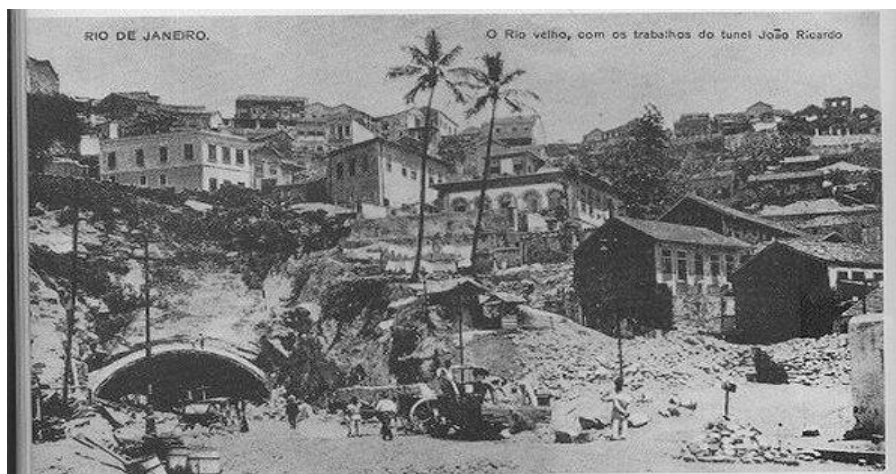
Foto do túnel João Ricardo sendo construído no local onde estava edificado o cortiço.
